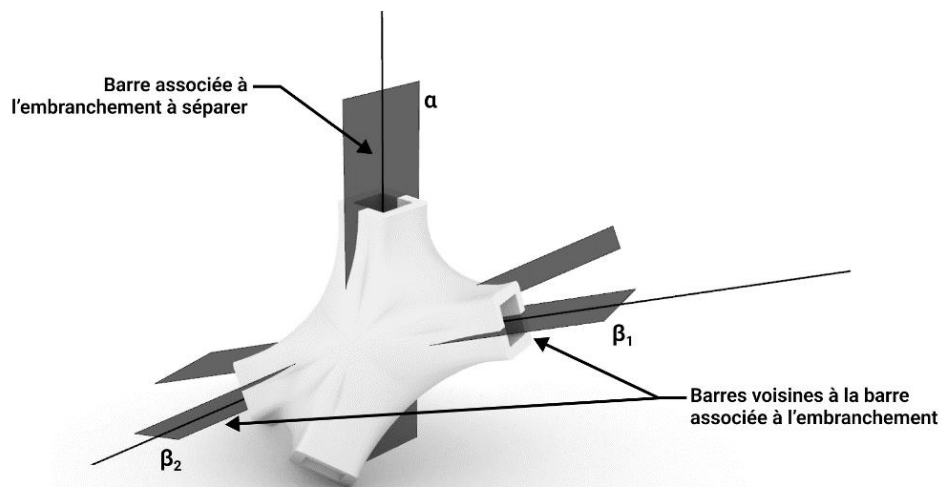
Définition des plans caractéristiques de la séparation d'un embranchement d'un nœud d'assemblage. Les plans α , β_1 et β_2 sont sécants au point d'intersection des fibres neutres des barres
